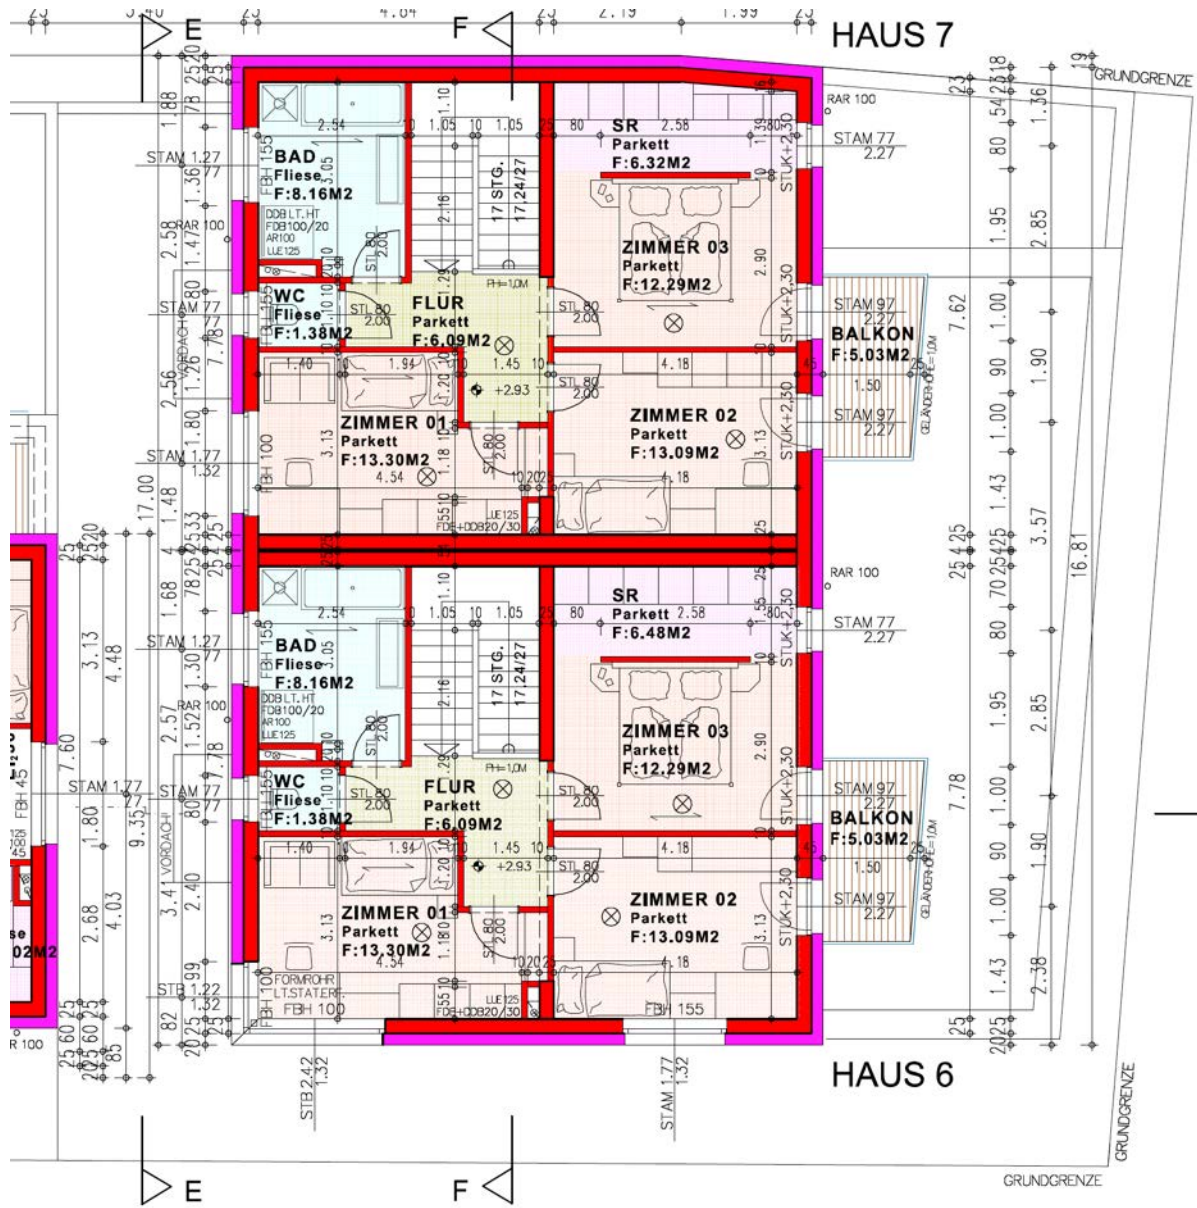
Einreichplan – Obergeschoss Haus 6+7 / Quelle: auftraggebende Partei
